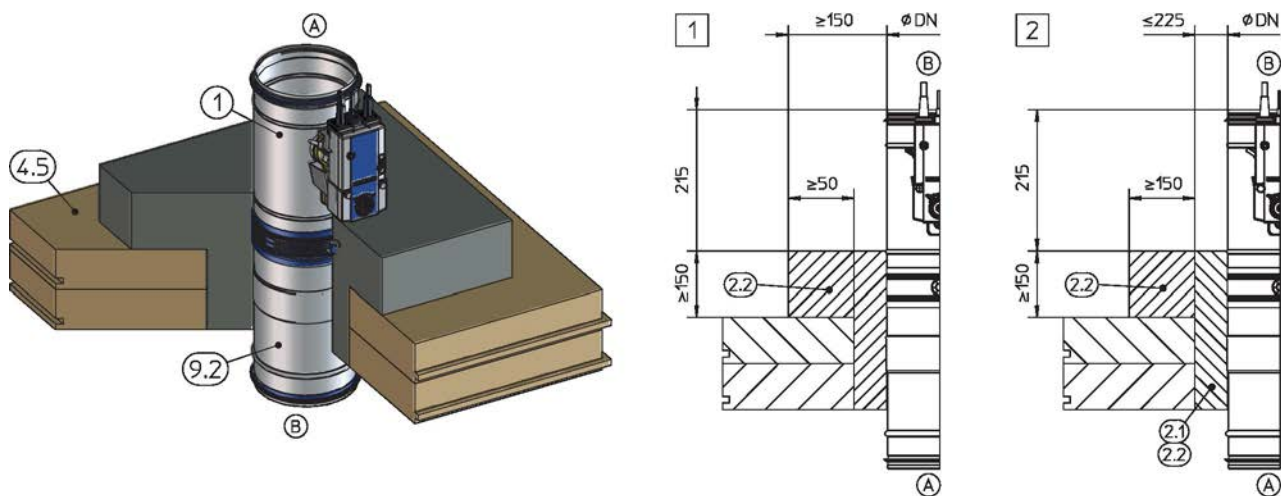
Installazione a base di malta in soffitti pieni a soletta in collegamento con soffitti con travi di legno/laminate, raffigurata verticale (applicabile anche per una disposizione sospesa)
